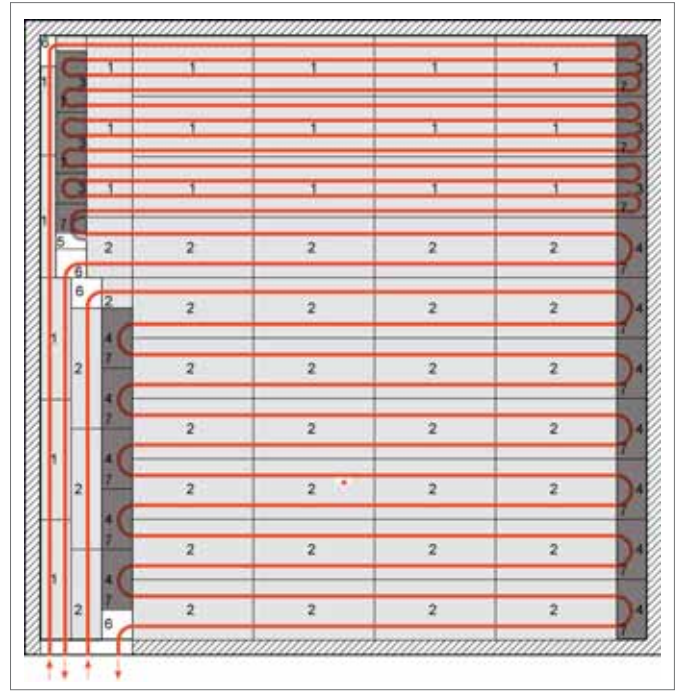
Ejemplo de un plano de colocación para el sistema en seco para pavimentos elásticos
